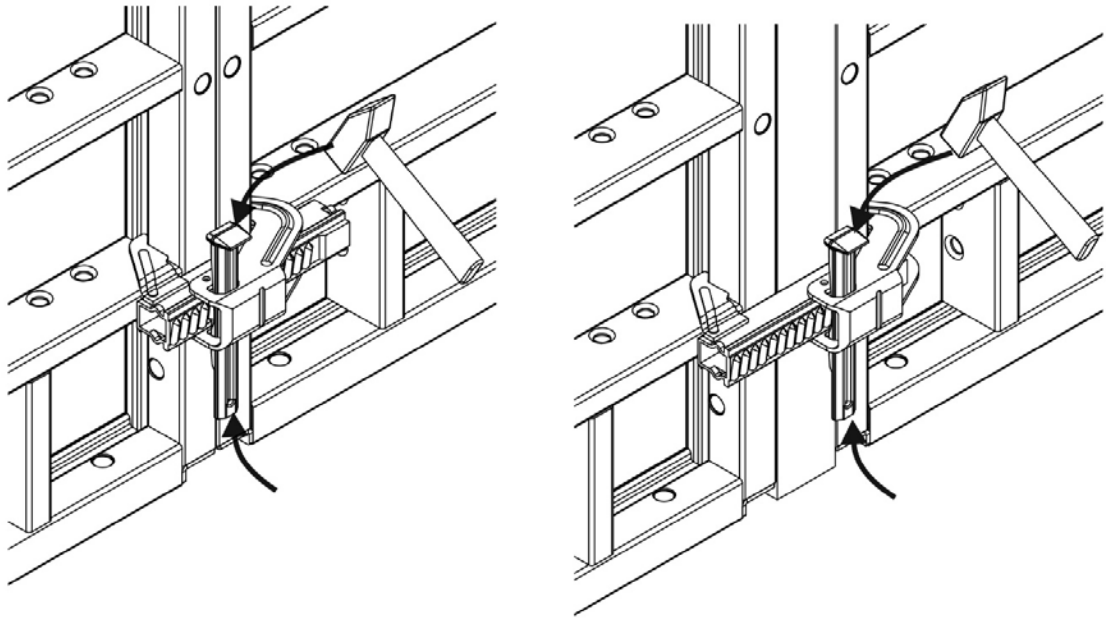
Монтаж універсального замка на щити вертикальної опалубки. [16]
